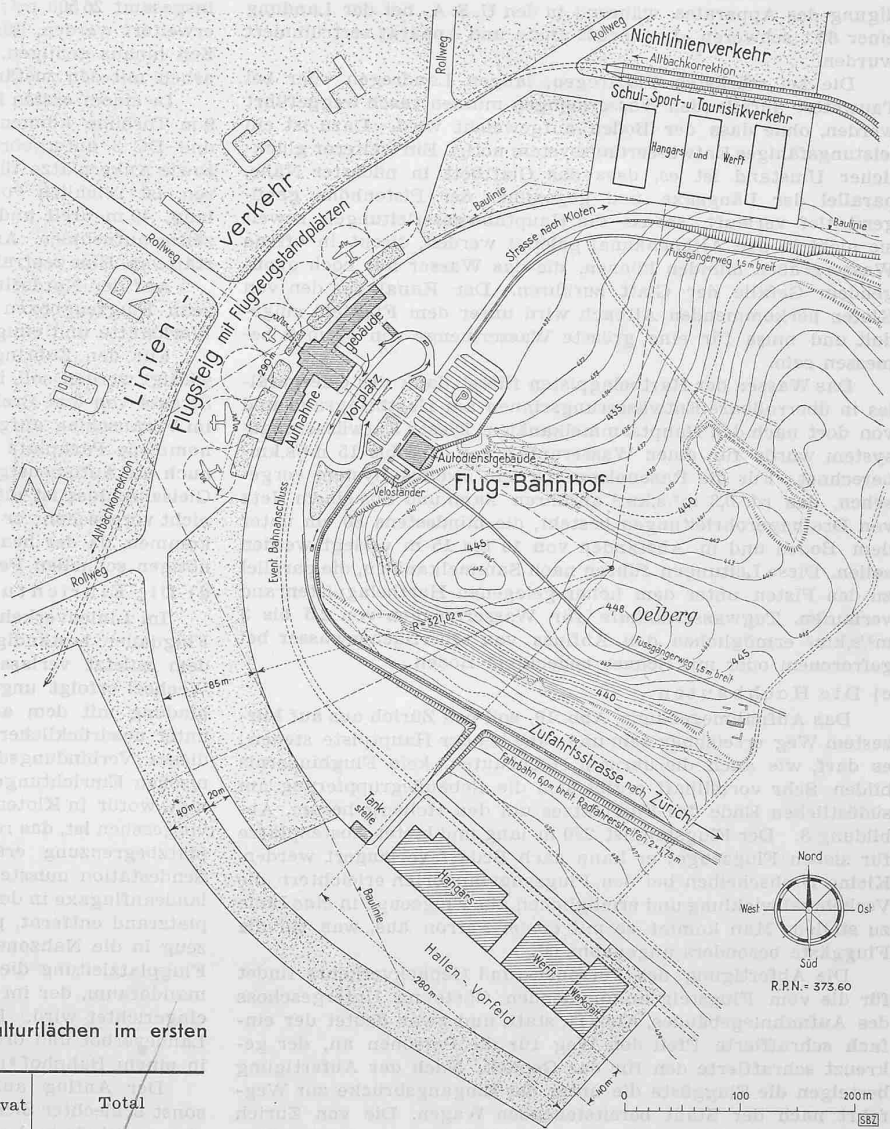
Situationsplan der Hochbauten. Masstab 1 : 6000
